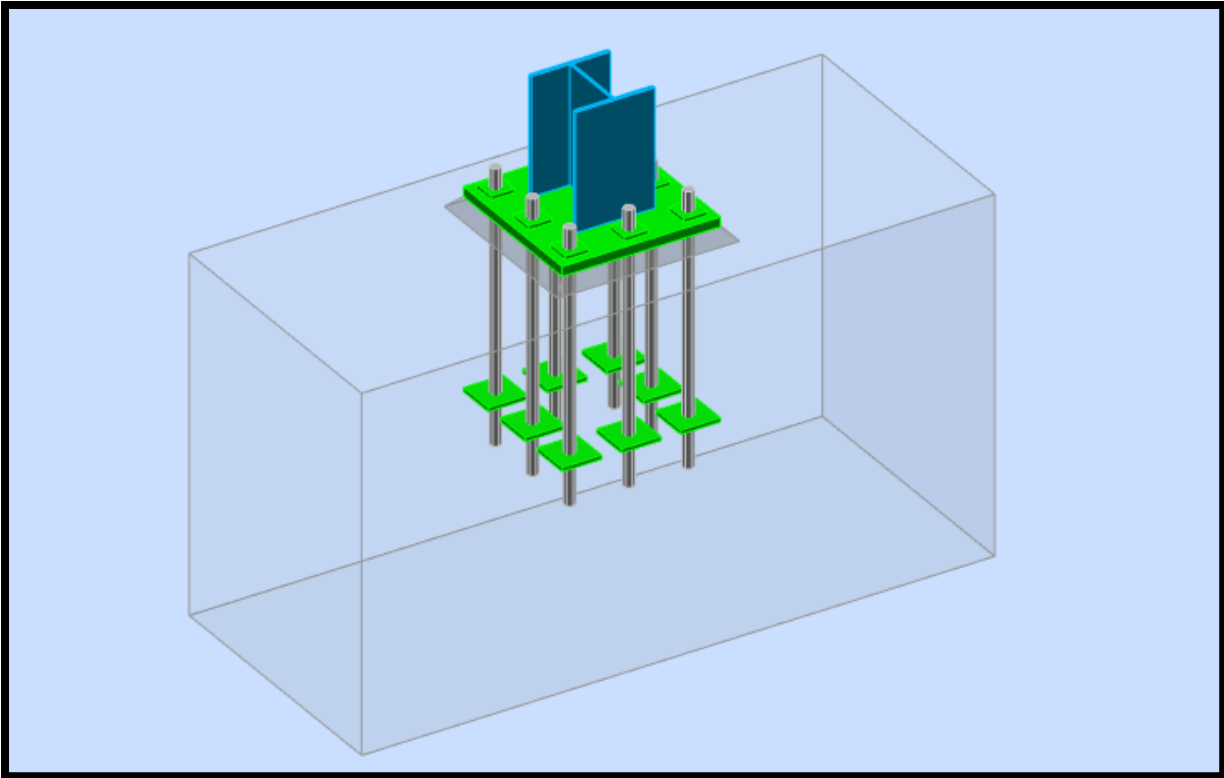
Vue d'assemblage pieds de poteau encastré.
